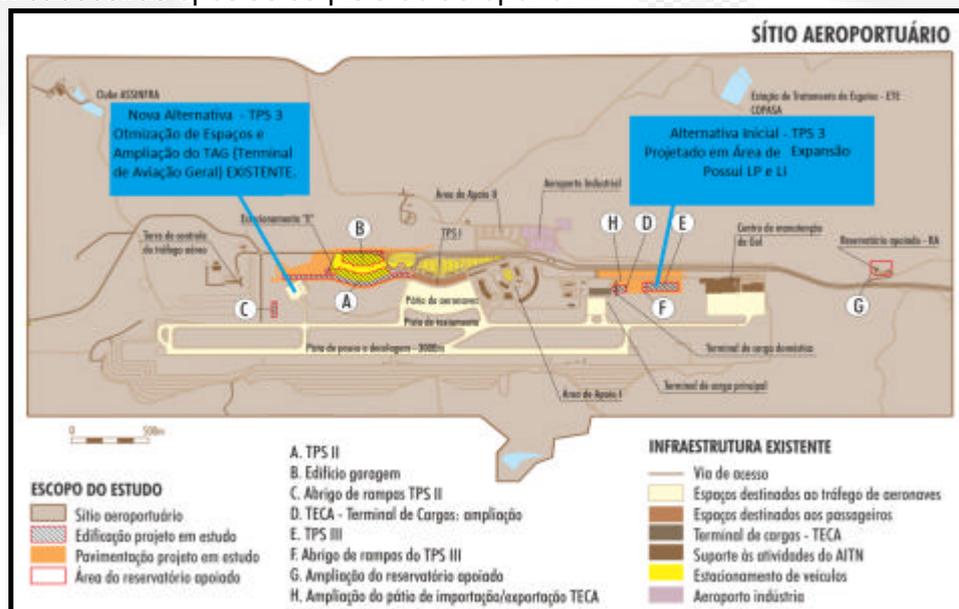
Imagem da modificação de implantação do TPS III. Fonte: protocolo nº R356922/2013.
